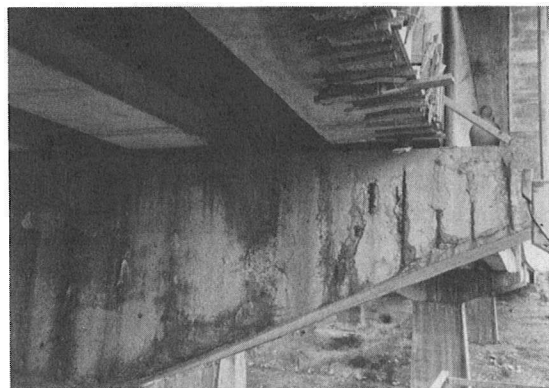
Detalle de un dintel de pila con armaduras corroídas.
